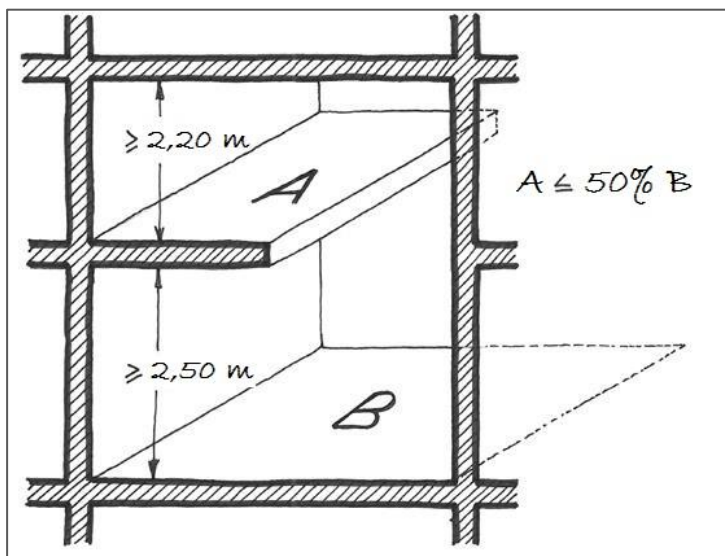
hauteur libre sous plafond en cas d'une mezzanine
